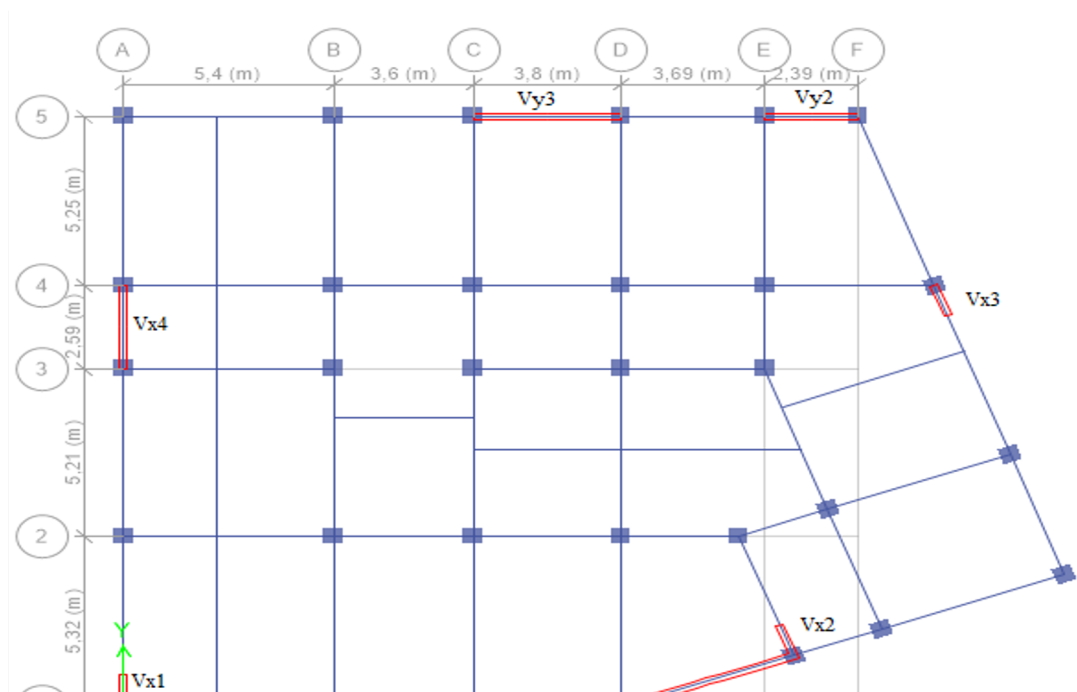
Vue en plan des éléments structuraux (Poteaux-Voiles) de la superstructure
